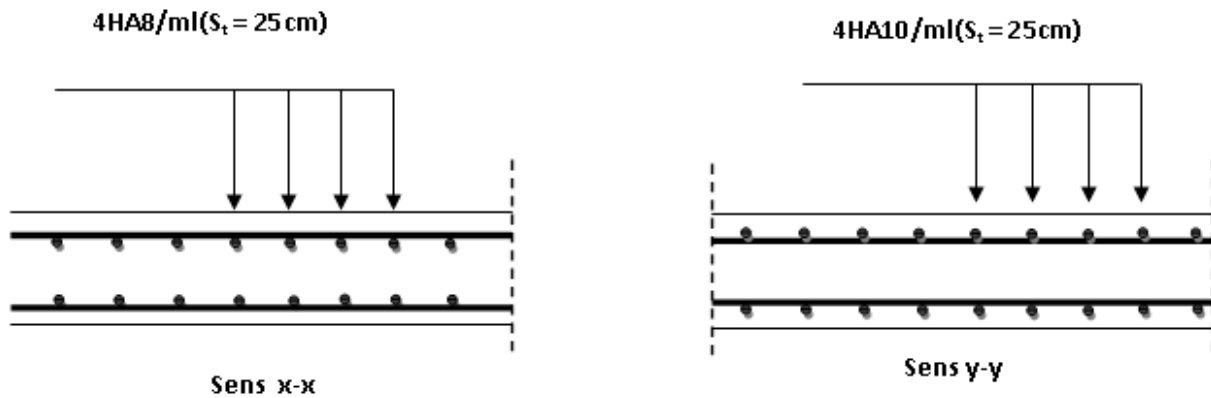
Ferrailage de la dalle pleine de la salle machine.
